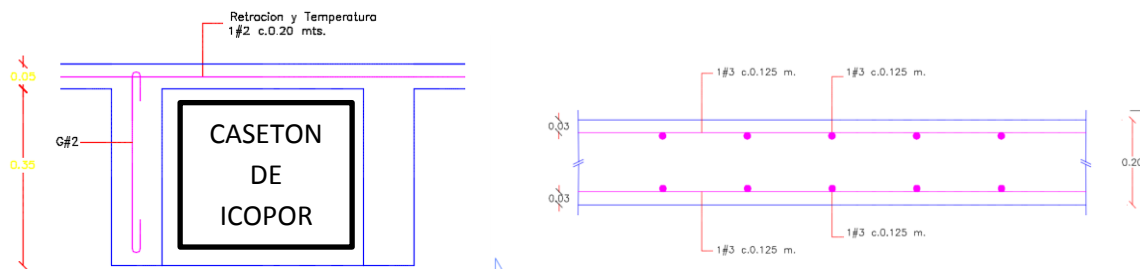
CORTE DE LOSA ALIGERADA, CORTE DE LOSA MACIZA
